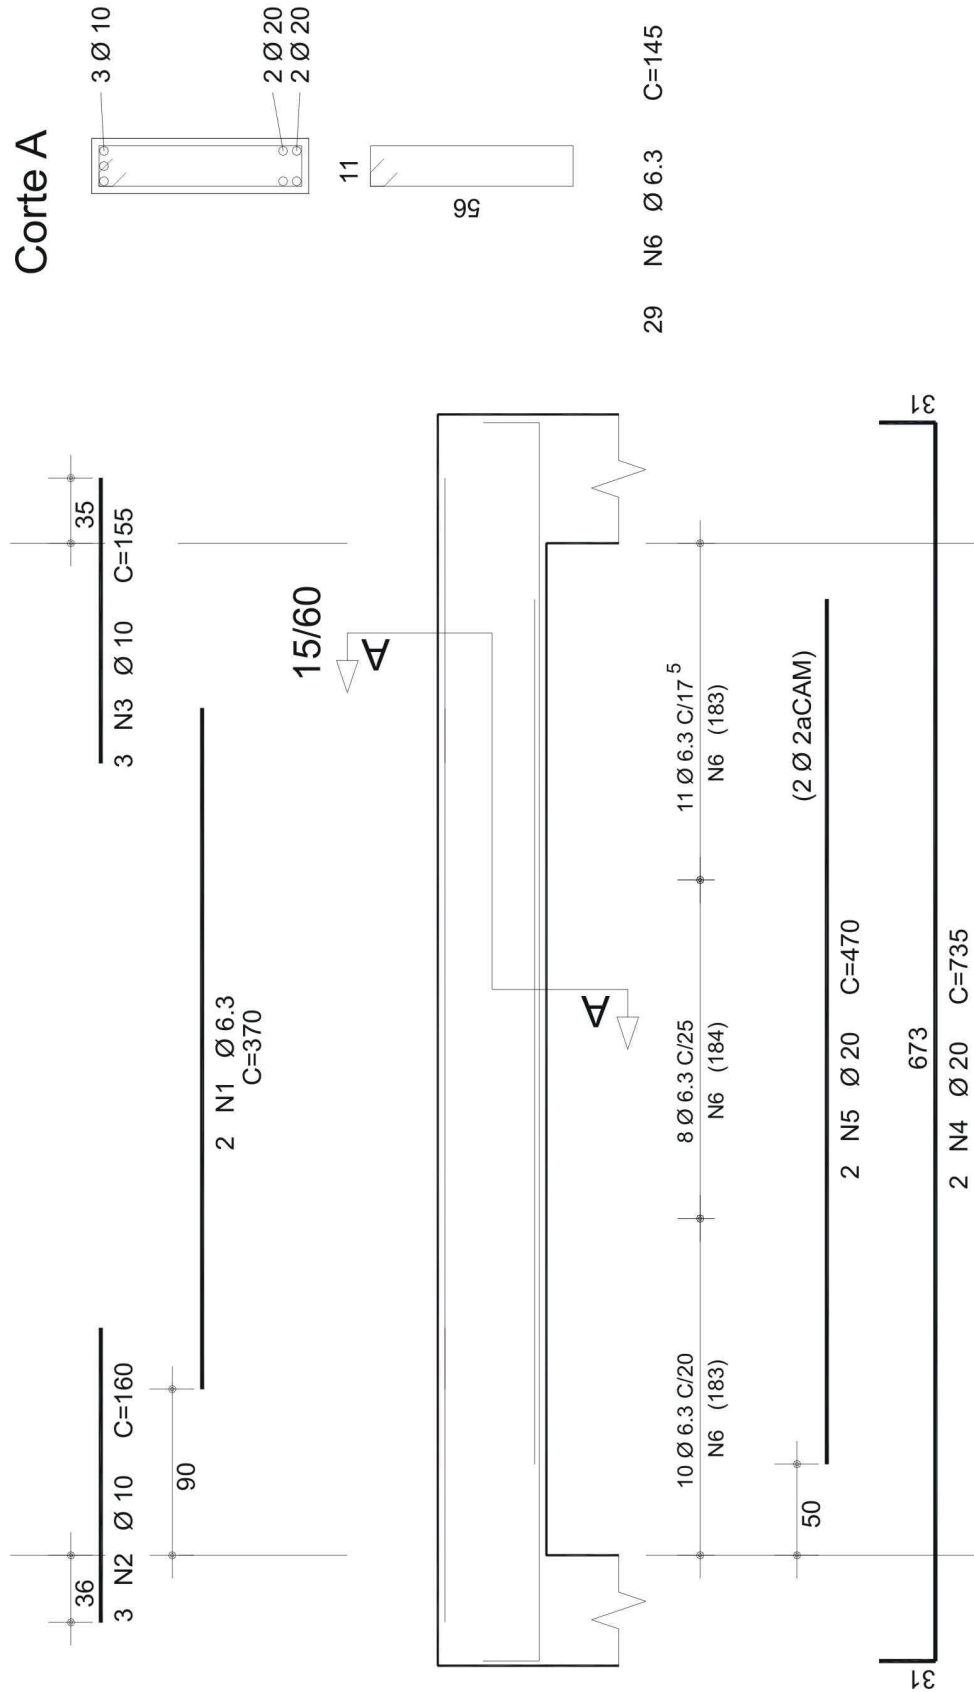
Detalhamento Viga 02, realizado pelo CAD/TQS.
